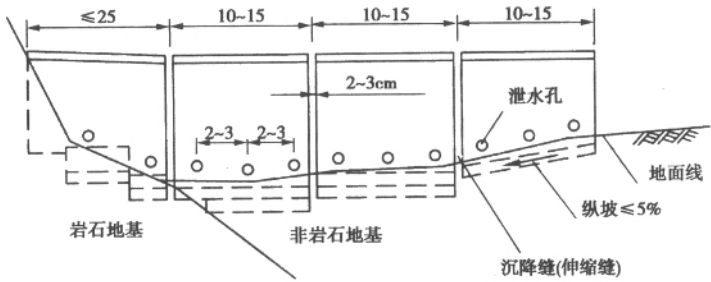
5—14 挡土墙纵向布置图(尺寸单位:m)
